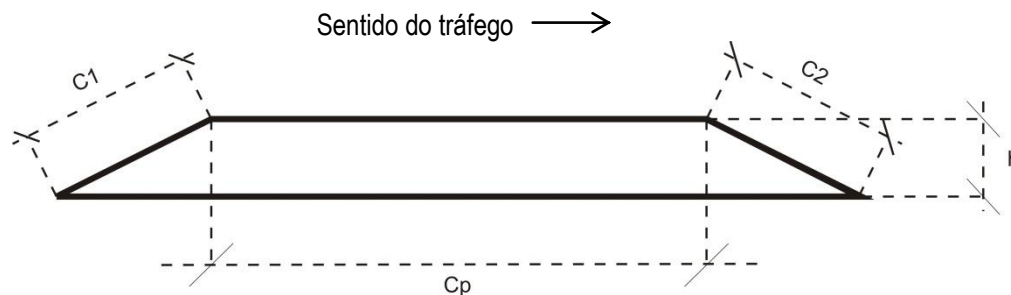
Plataforma com perfil trapezoidal – Corte AA
